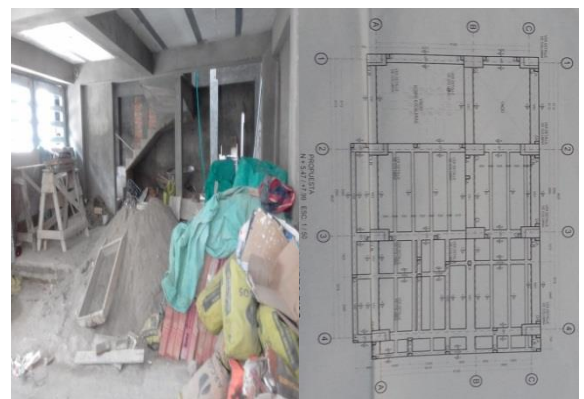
Modificación del espaciamiento entre vigas fuente propia
